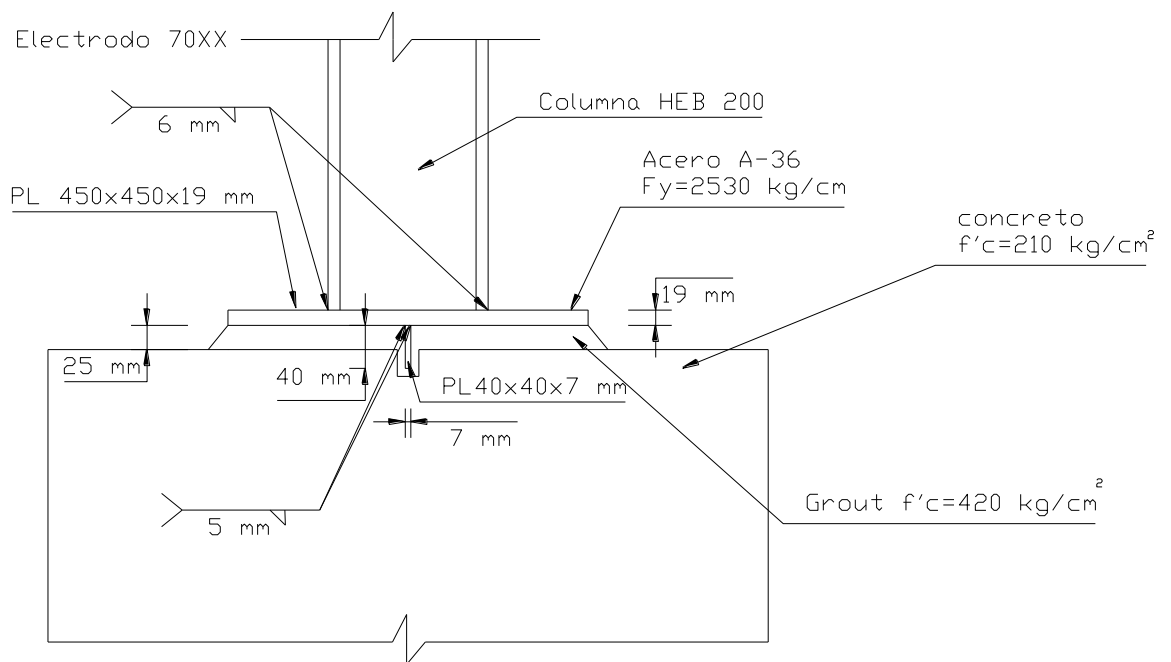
Detallado con Llave de Corte del Ejemplo 12.
